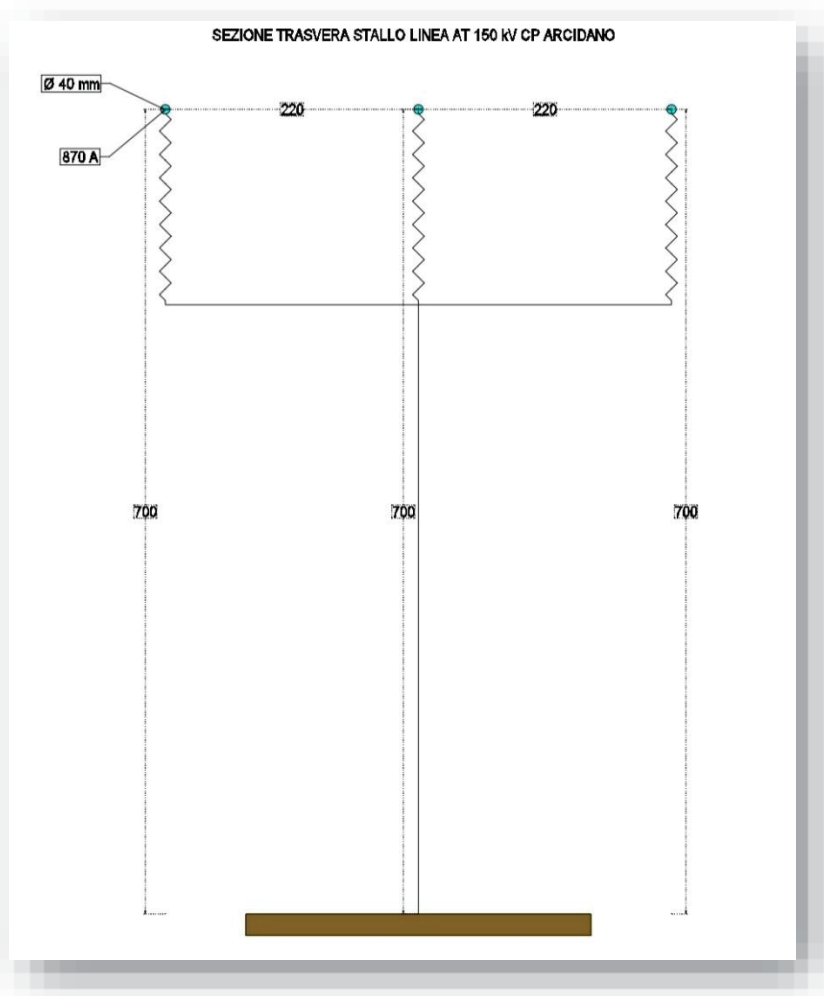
schematico sezione trasversale sbarre AT stazione utente
